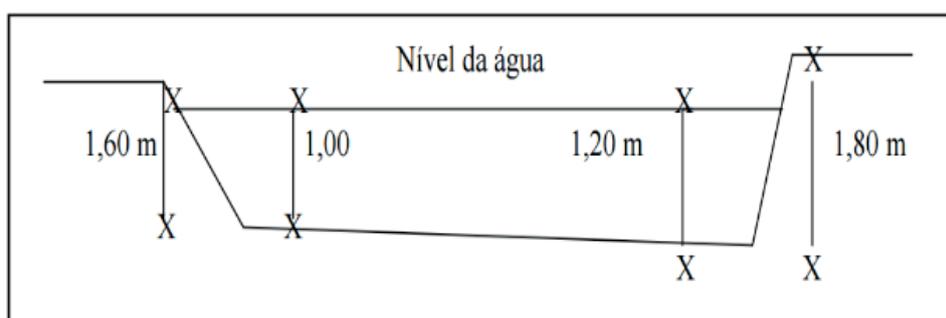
Dimensões ideais recomendadas para construção de viveiros para tilápias.
